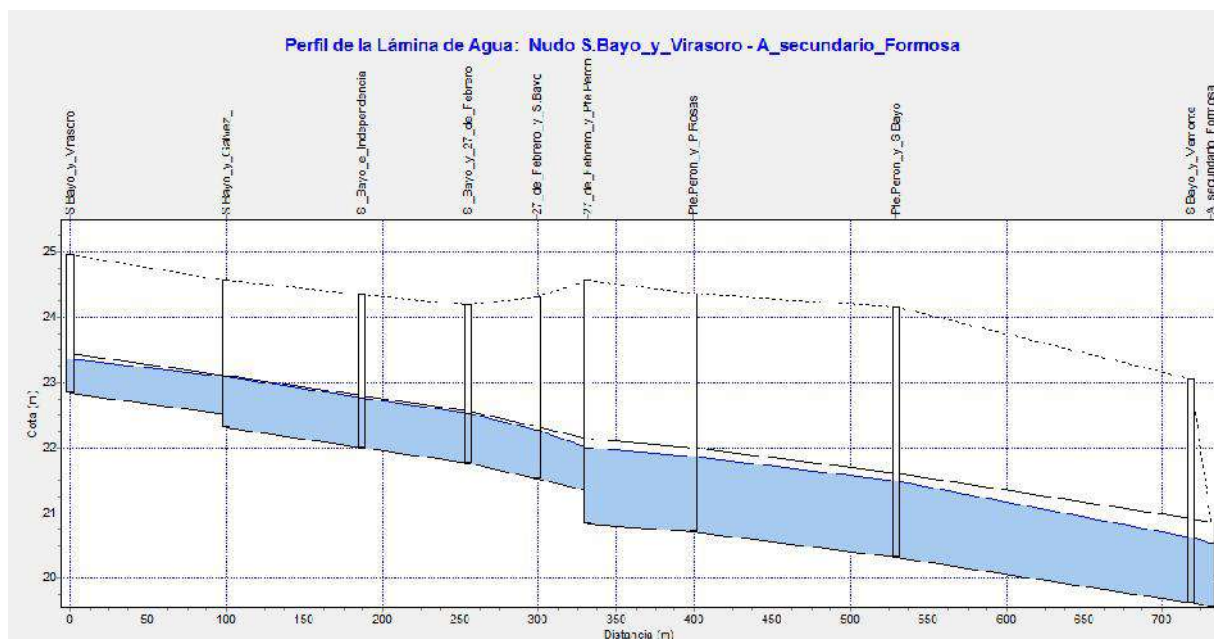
Perfiles de conductos a construir por calle S. Bayo
